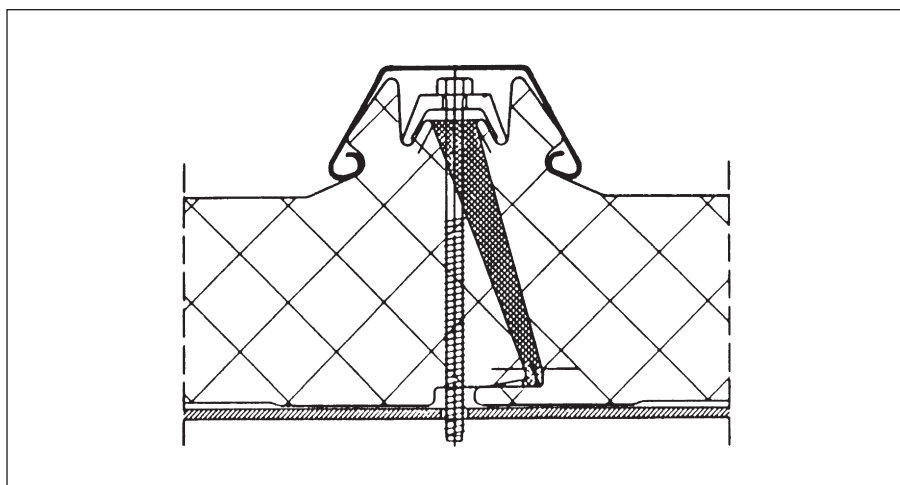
Verdeckte Dachelement-Befestigung mittels verdeckter Schraube
